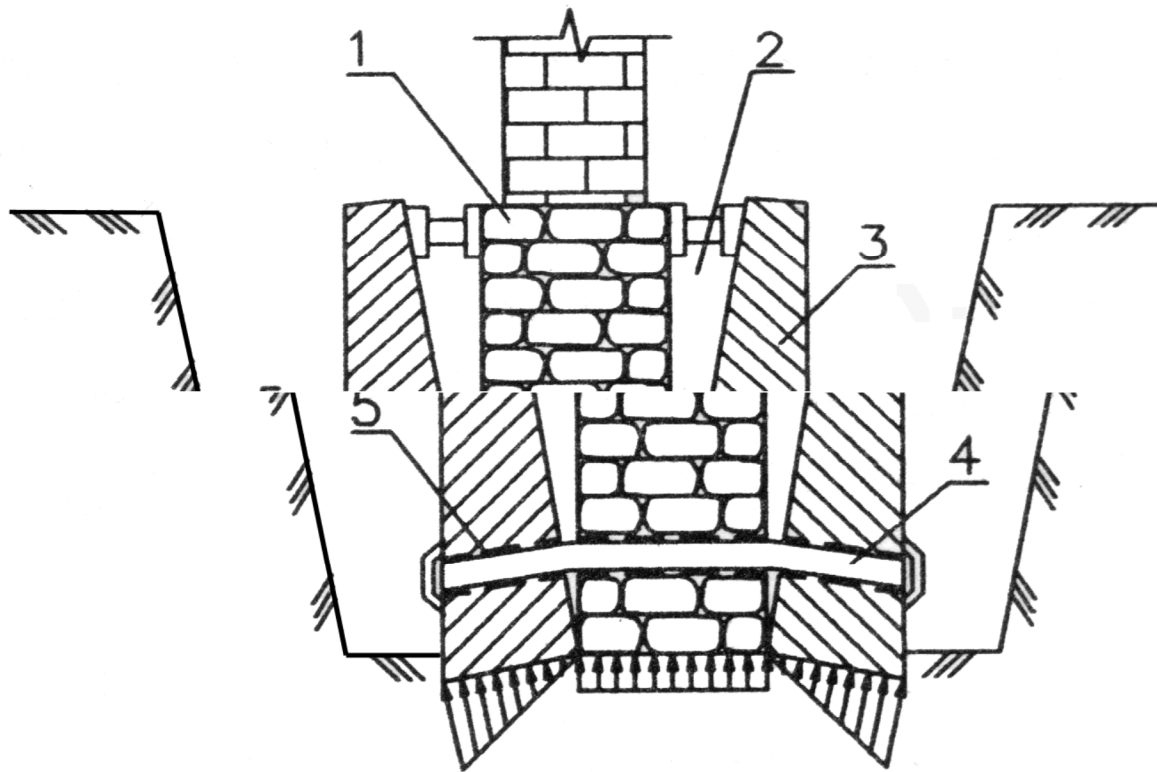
Підсилення фундаментів додатковими блоками, обжимаються ґрунти основи за їхнього повороту:
